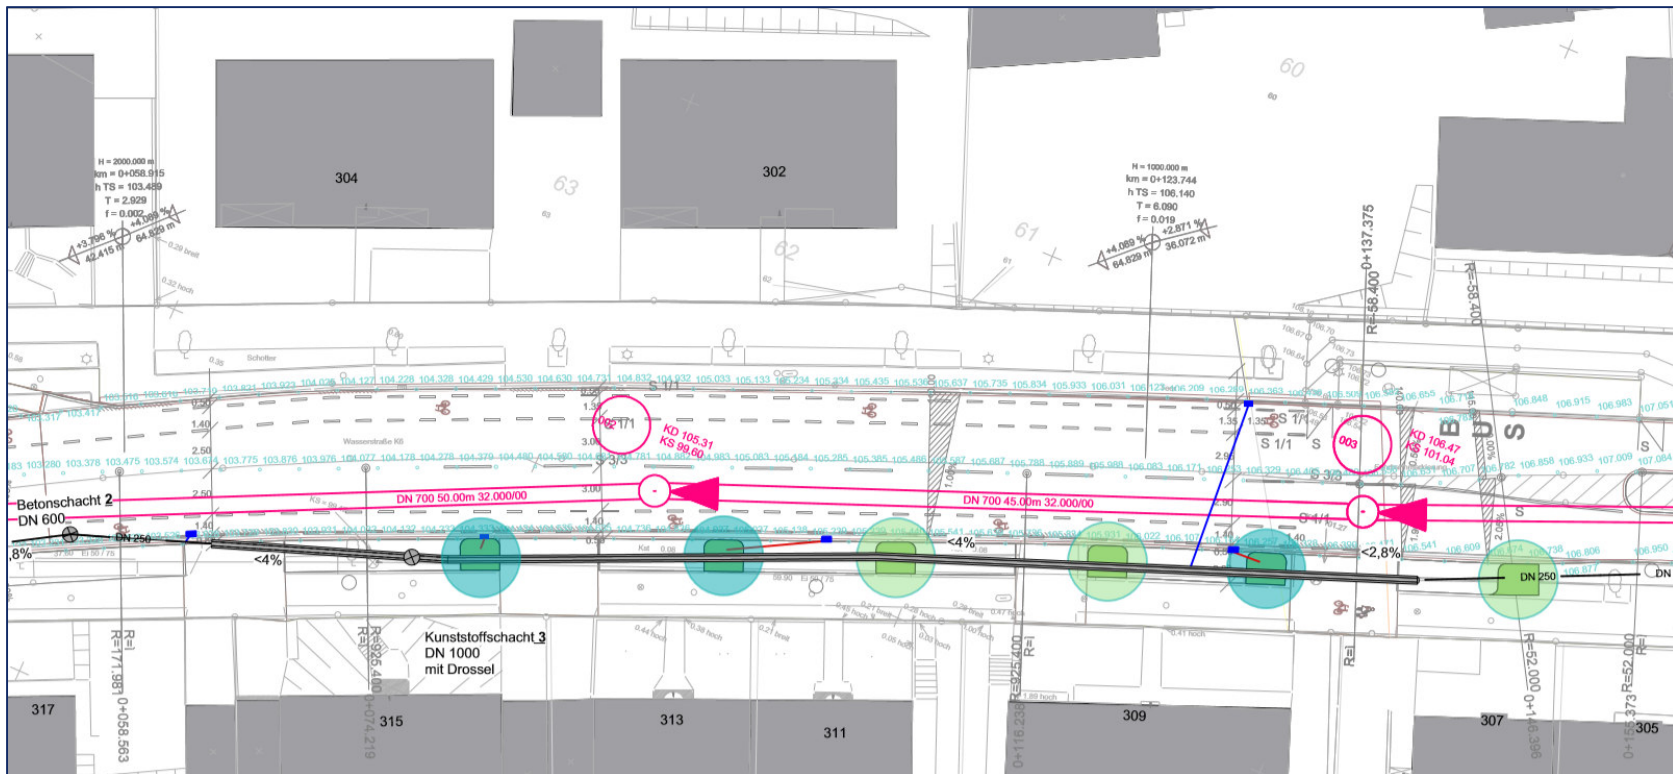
Ausschnitt Entwässerungslageplan mit vernetzten Rigolen
